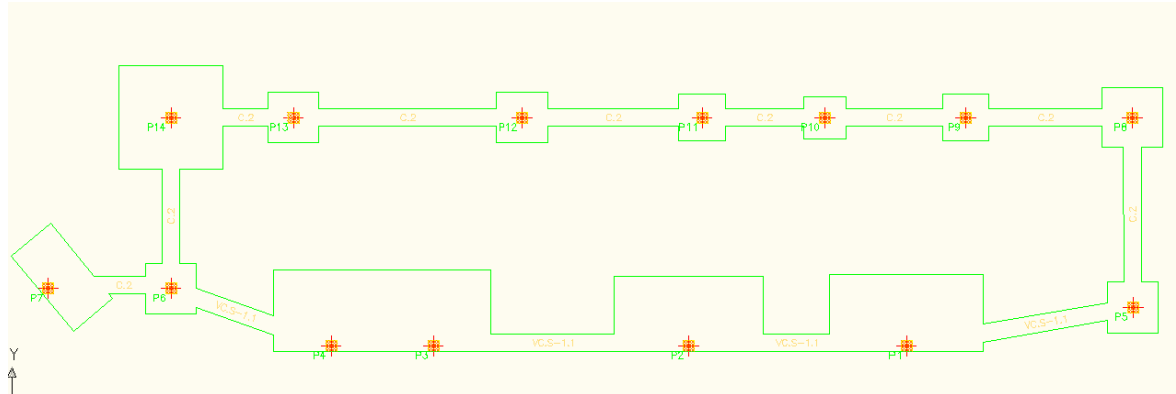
Esquema geral de sapatas e vigas de equilíbrio.
